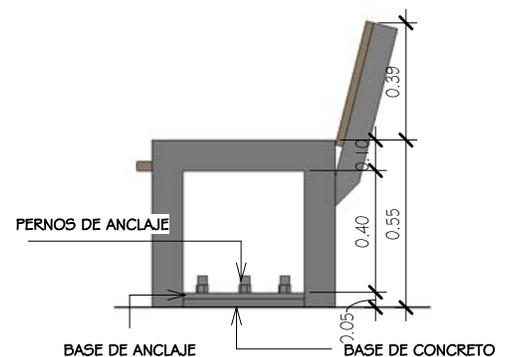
Diseño de Banca BSM. Elaboración: Propia.
